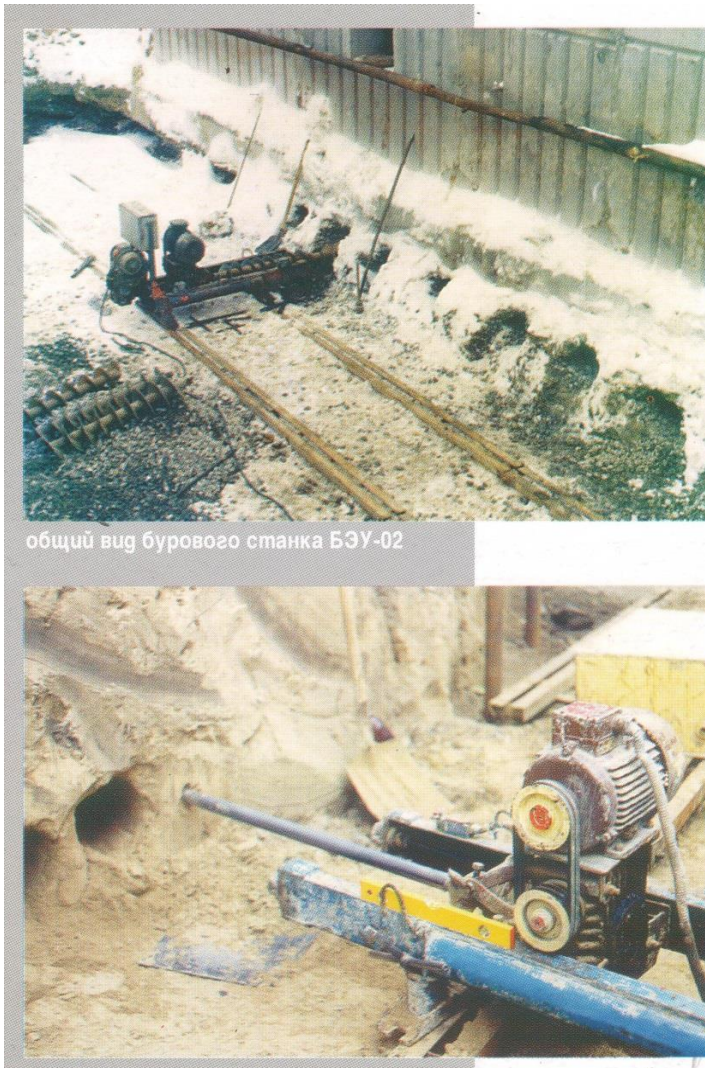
Схема виконання вибурування свердловин в грунтах основ фундаментів.
